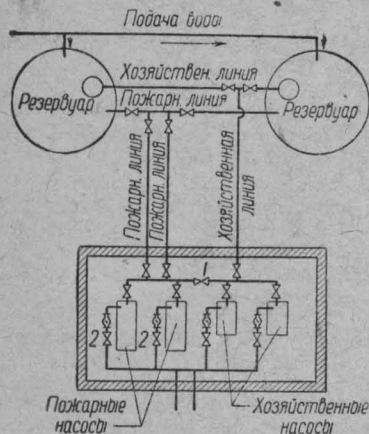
Схема узла трубопроводов у насосной станции (1-й тип).
